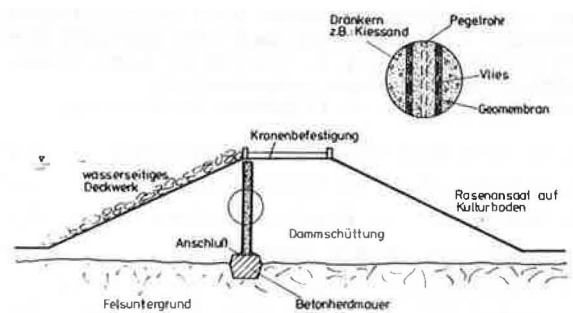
Systemaufbau Geomembran/Geotextil-Kerndichtung
